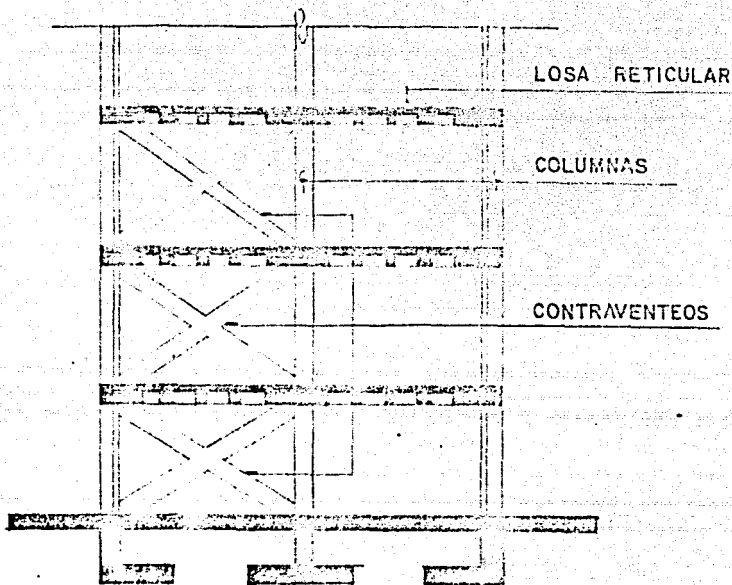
Estructura esquelética con losa reticular y elementos rigidizantes.
